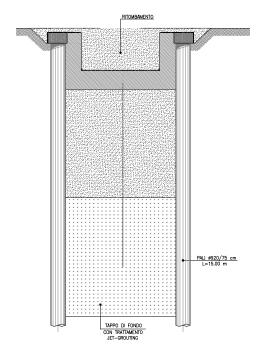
Getto del solettone di copertura e delle pareti laterali, Impermeabilizzazione interna e ritombamento della struttura ad U
